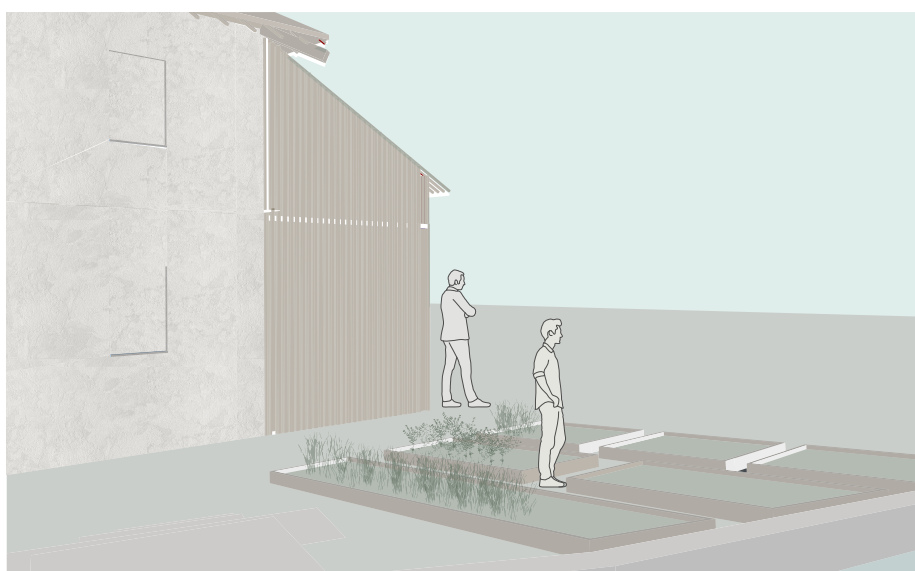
Vista di progetto, orto didattico (tav. 11.1).
